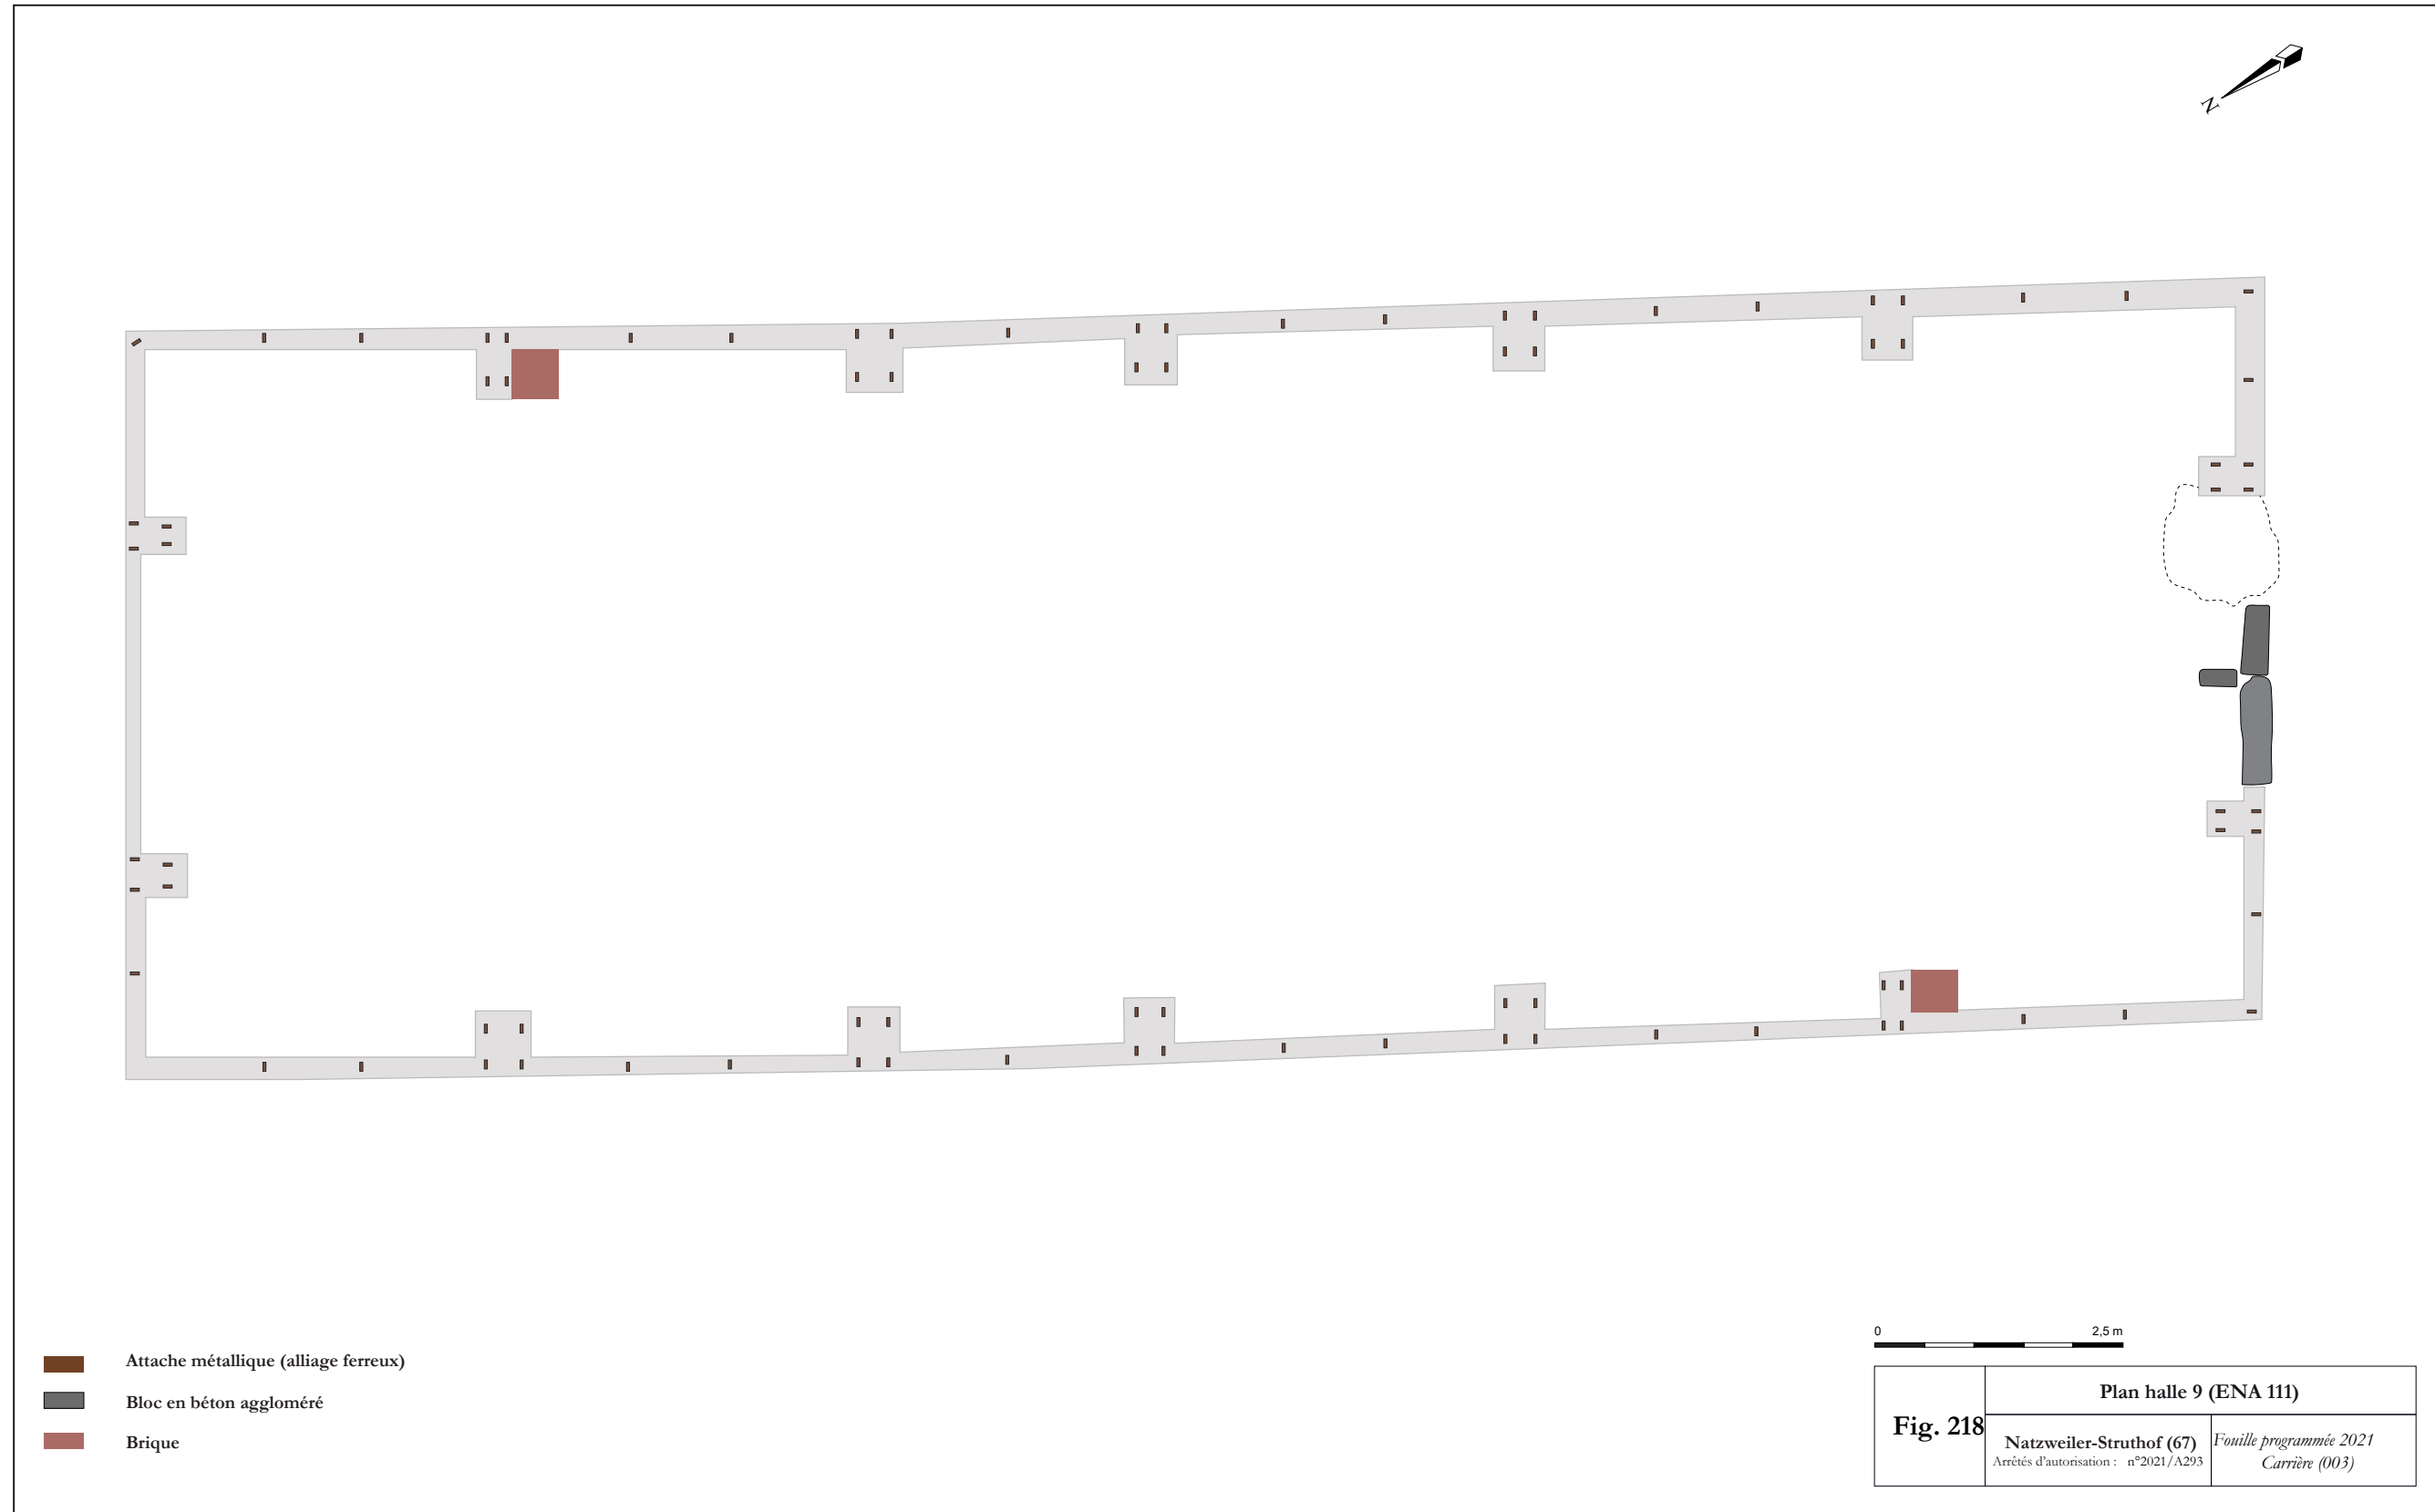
Plan de la halle 9, ENA 111 (DAO : T. Aubry et J. Brangé).
